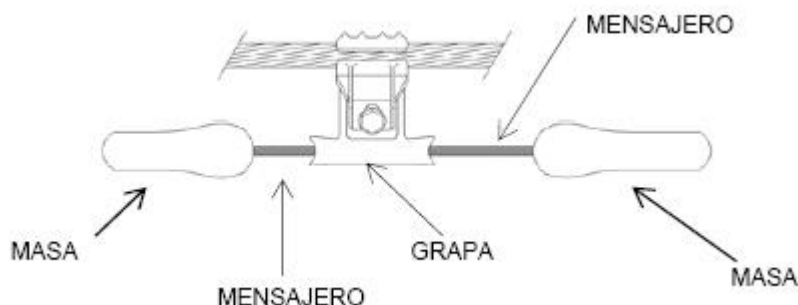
Instalación de amortiguador tipo Stock bridge
